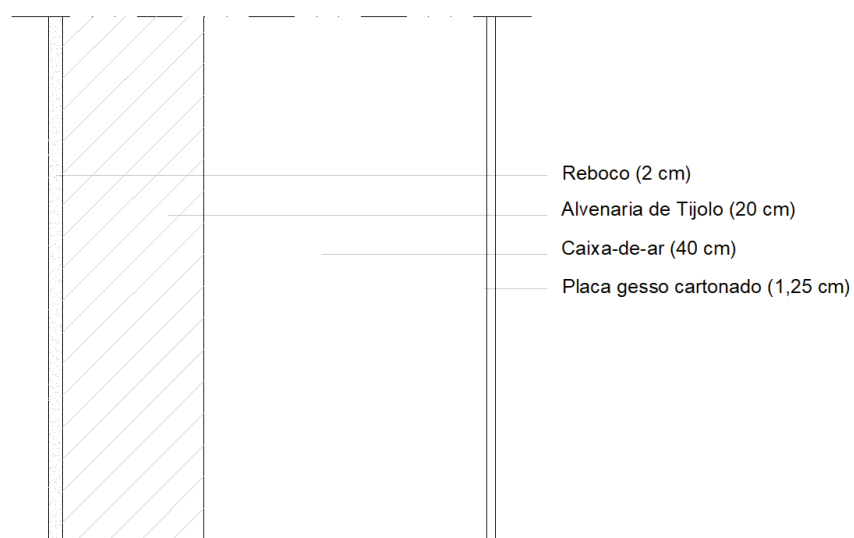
Pormenor construtivo da parede interior tipo XX (Instalação sanitária)
